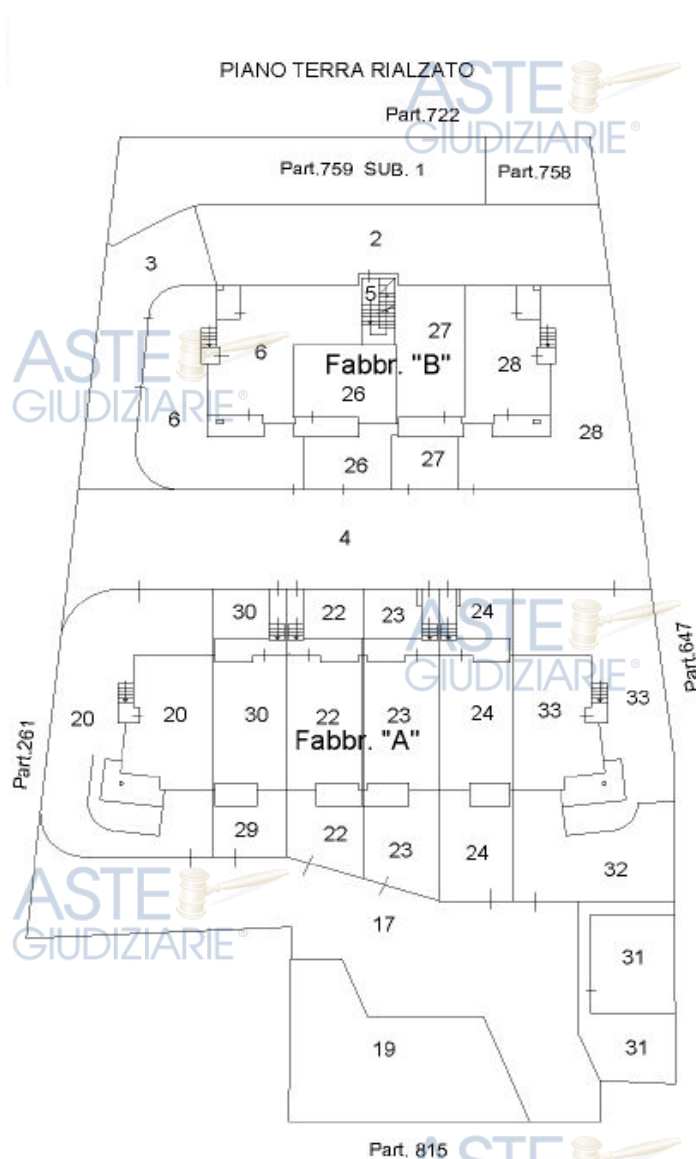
Elaborato planimetrico – fabbricato “B” confinante a Sud con il fabbricato “A”
